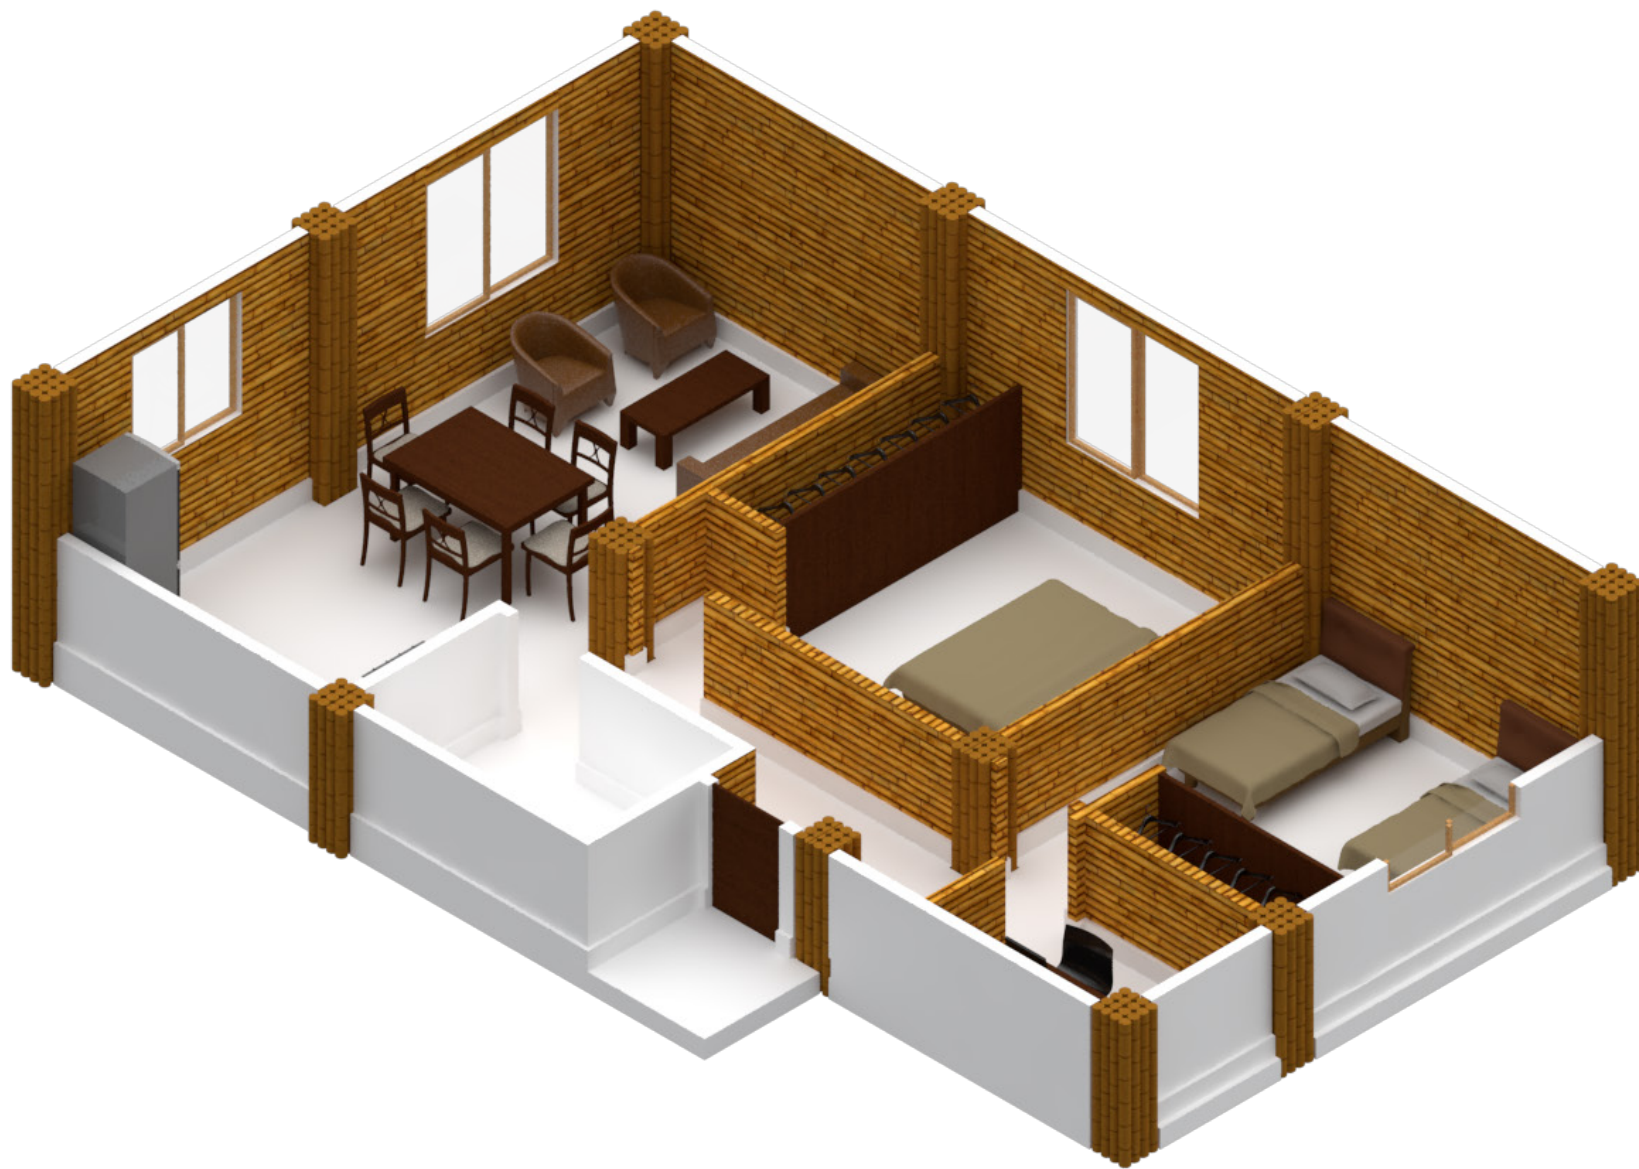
Axonometría vivienda tipo 3 planta alta 2. Departamento 6
